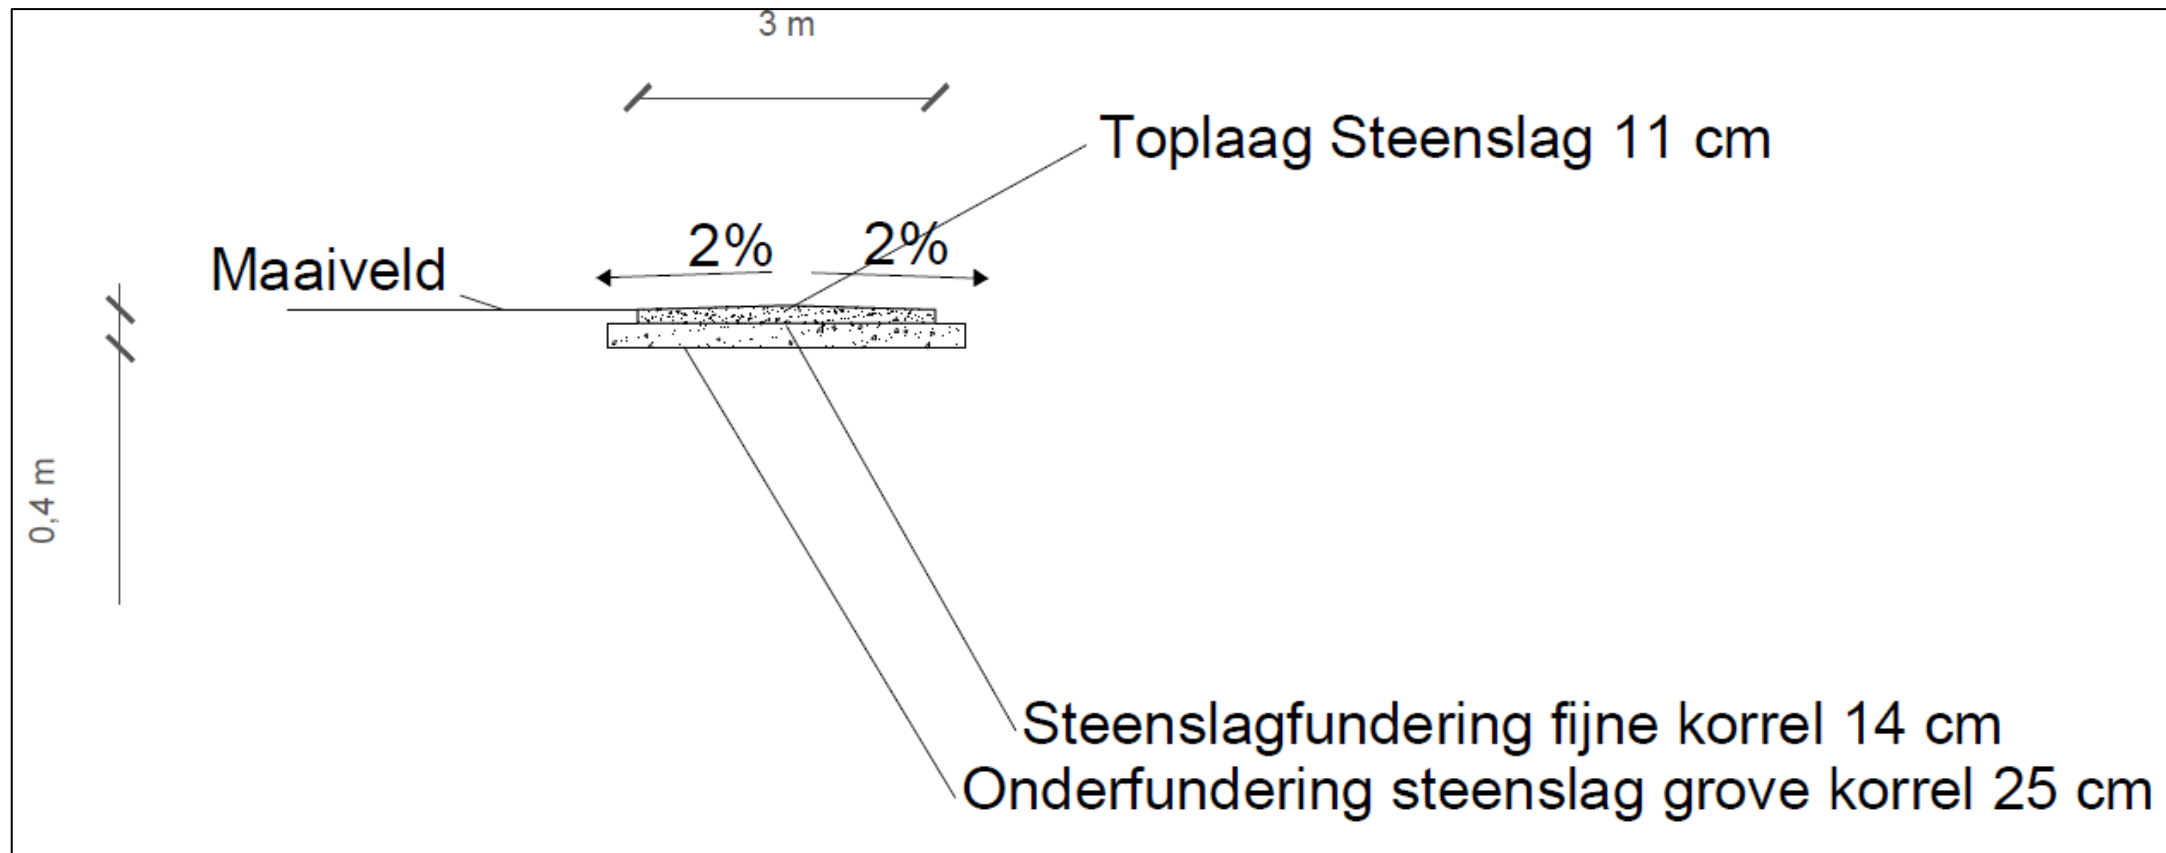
Plan voor WT1 (bron: opdrachtgever).
